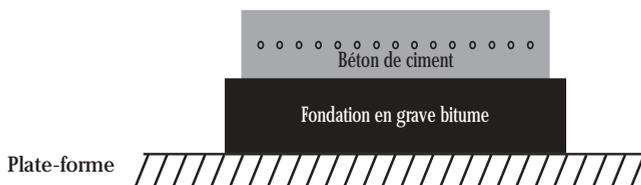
structure composite constituée d'un revêtement béton à joints non goujonnés posé sur une fondation en grave-bitume.
